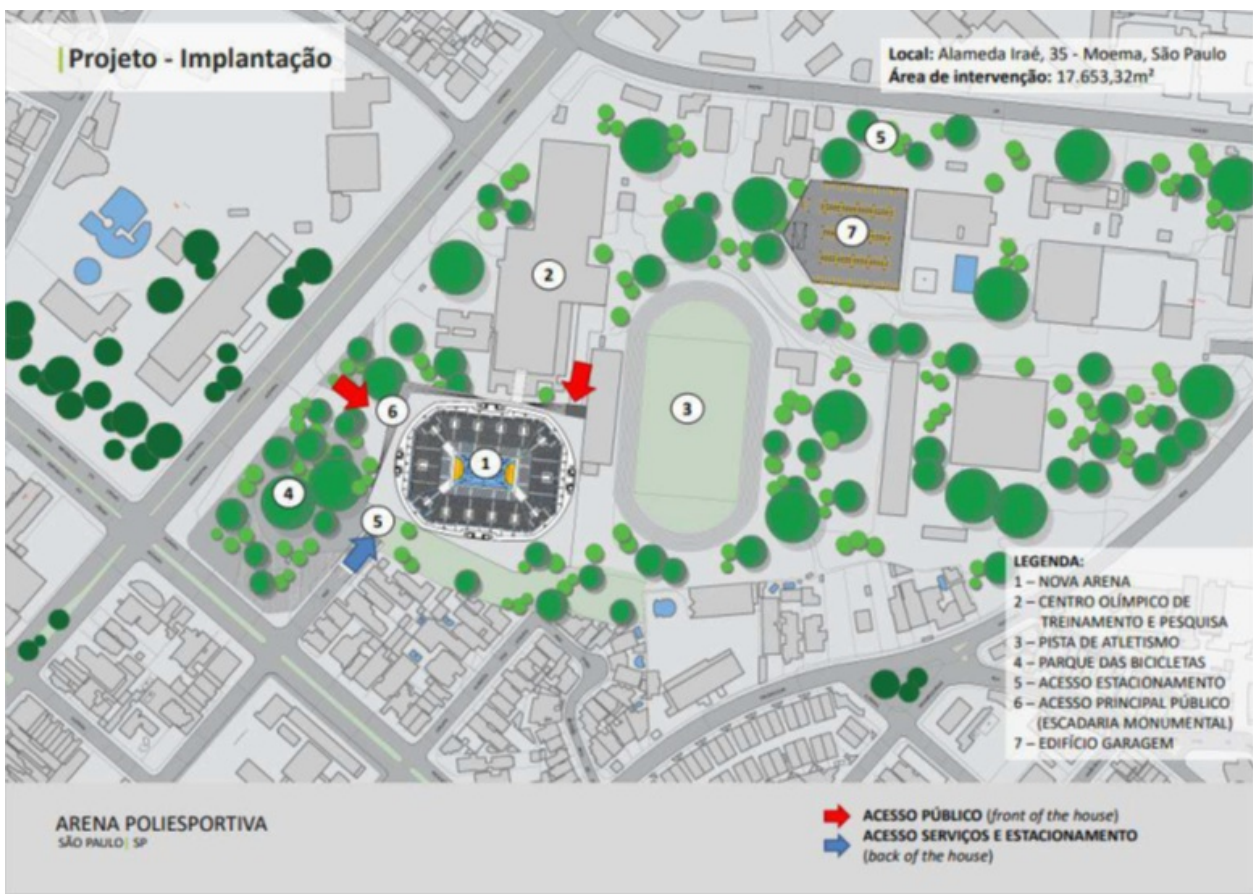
Previsão de layout de implantação da Arena Esportiva e do Edifício Garagem.
